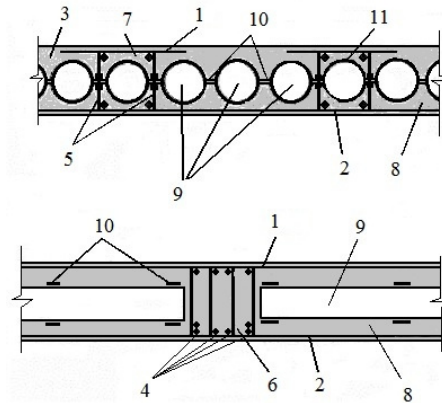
Поперечные сечения облегченного перекрытия: 1, 2 – арматура верхней и нижней сеток; 3 – балочная плита; 4, 5 – арматурный каркас главной и второстепенной балок; 6, 7 – главная и второстепенная балки; 8 – нижний слой бетона перекрытия; 9 – собранные в пакет вкладыши; 10, 11 – соединительное крепление
